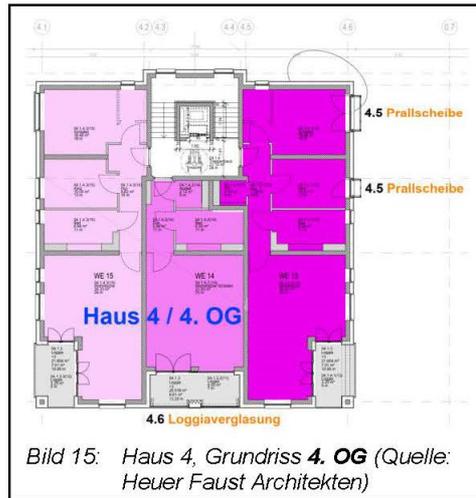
Haus 4, Grundriss 4. OG (Quelle: Heuer Faust Architekten)
